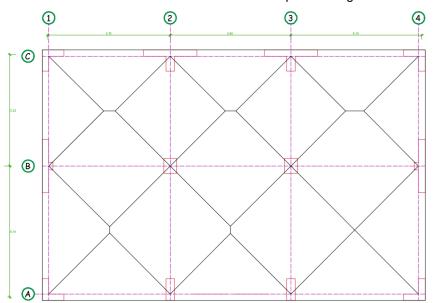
Áreas tributarias de losa de cimentación para las vigas de cimentación.
